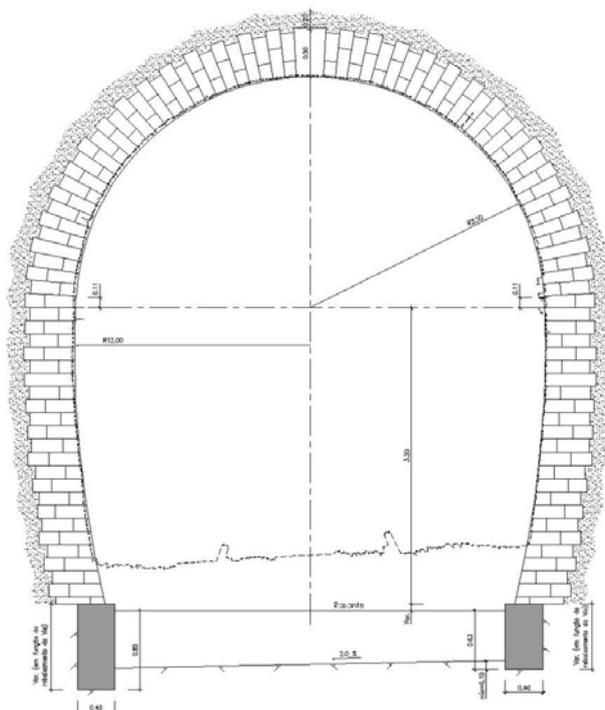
Figura VII - Secção do revestimento de alvenaria existente com recalçamento
